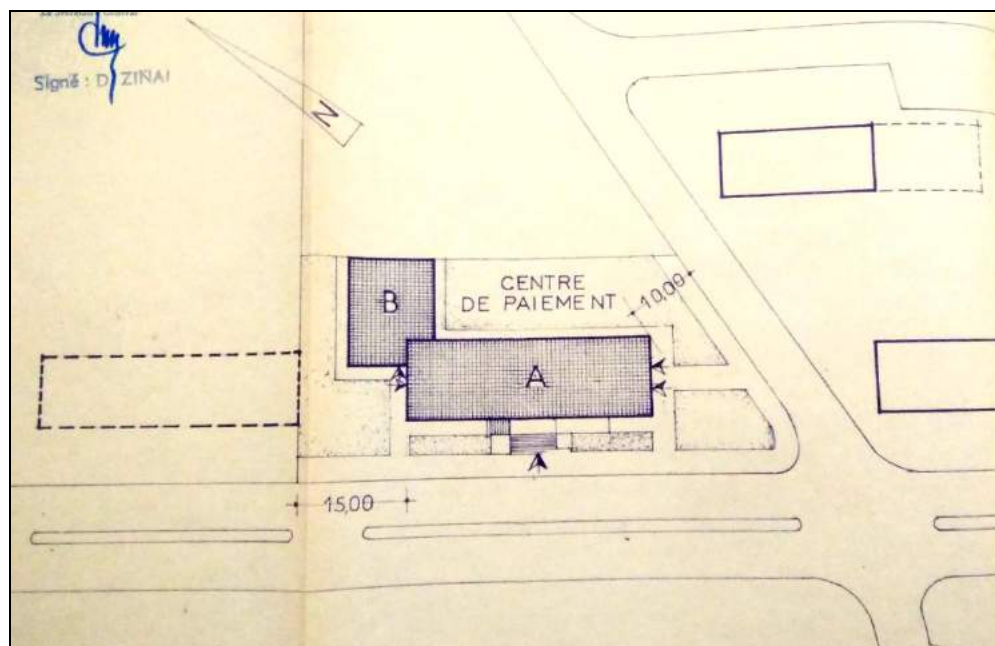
Plan de masse, source : permis de construire, 1972, archive wilaya de Saïda.
